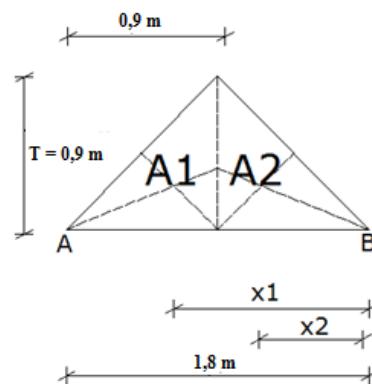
Detail Pembebanan Balok Anak Arah Melintang
